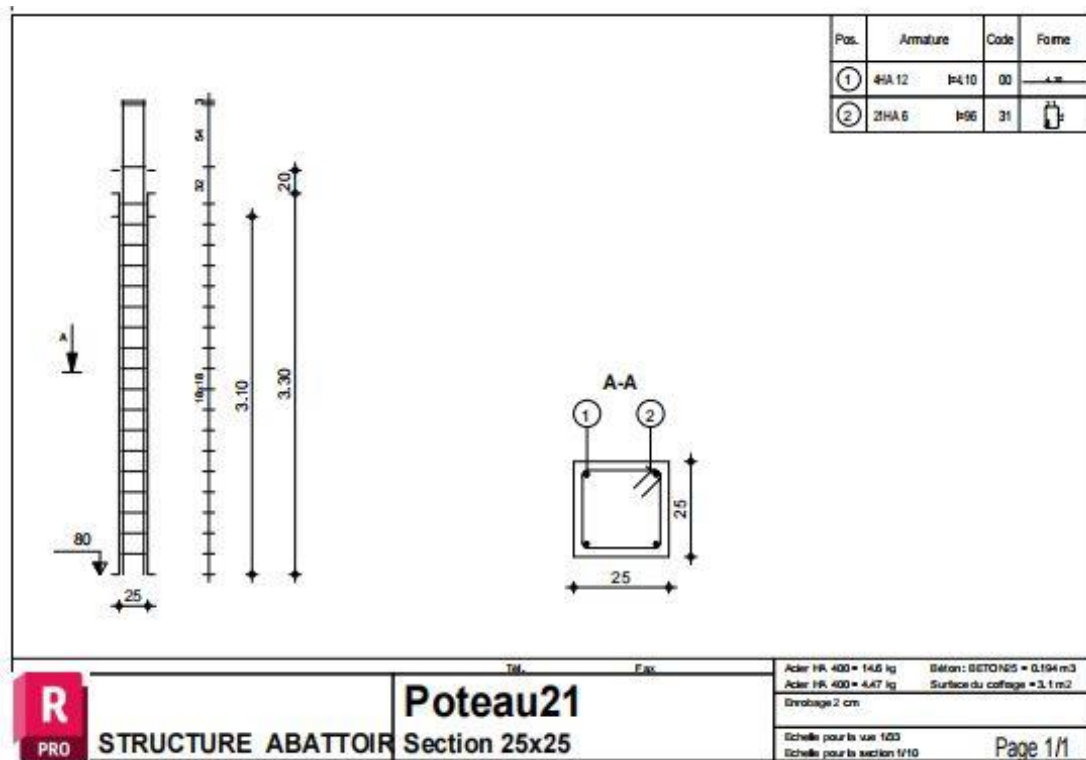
Plan d'exécution du poteau le plus chargé.
